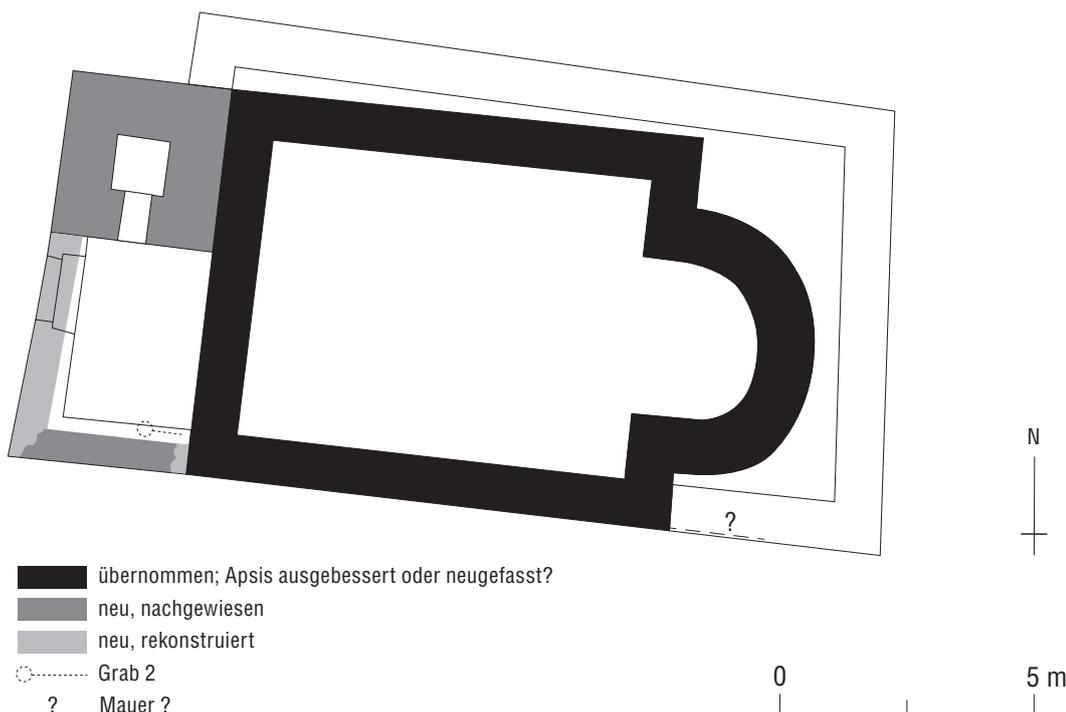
Breil/Brigels, Sogn Sievi. 2018/2020. Grundriss 11. Jahrhundert. Mst. 1:150.
